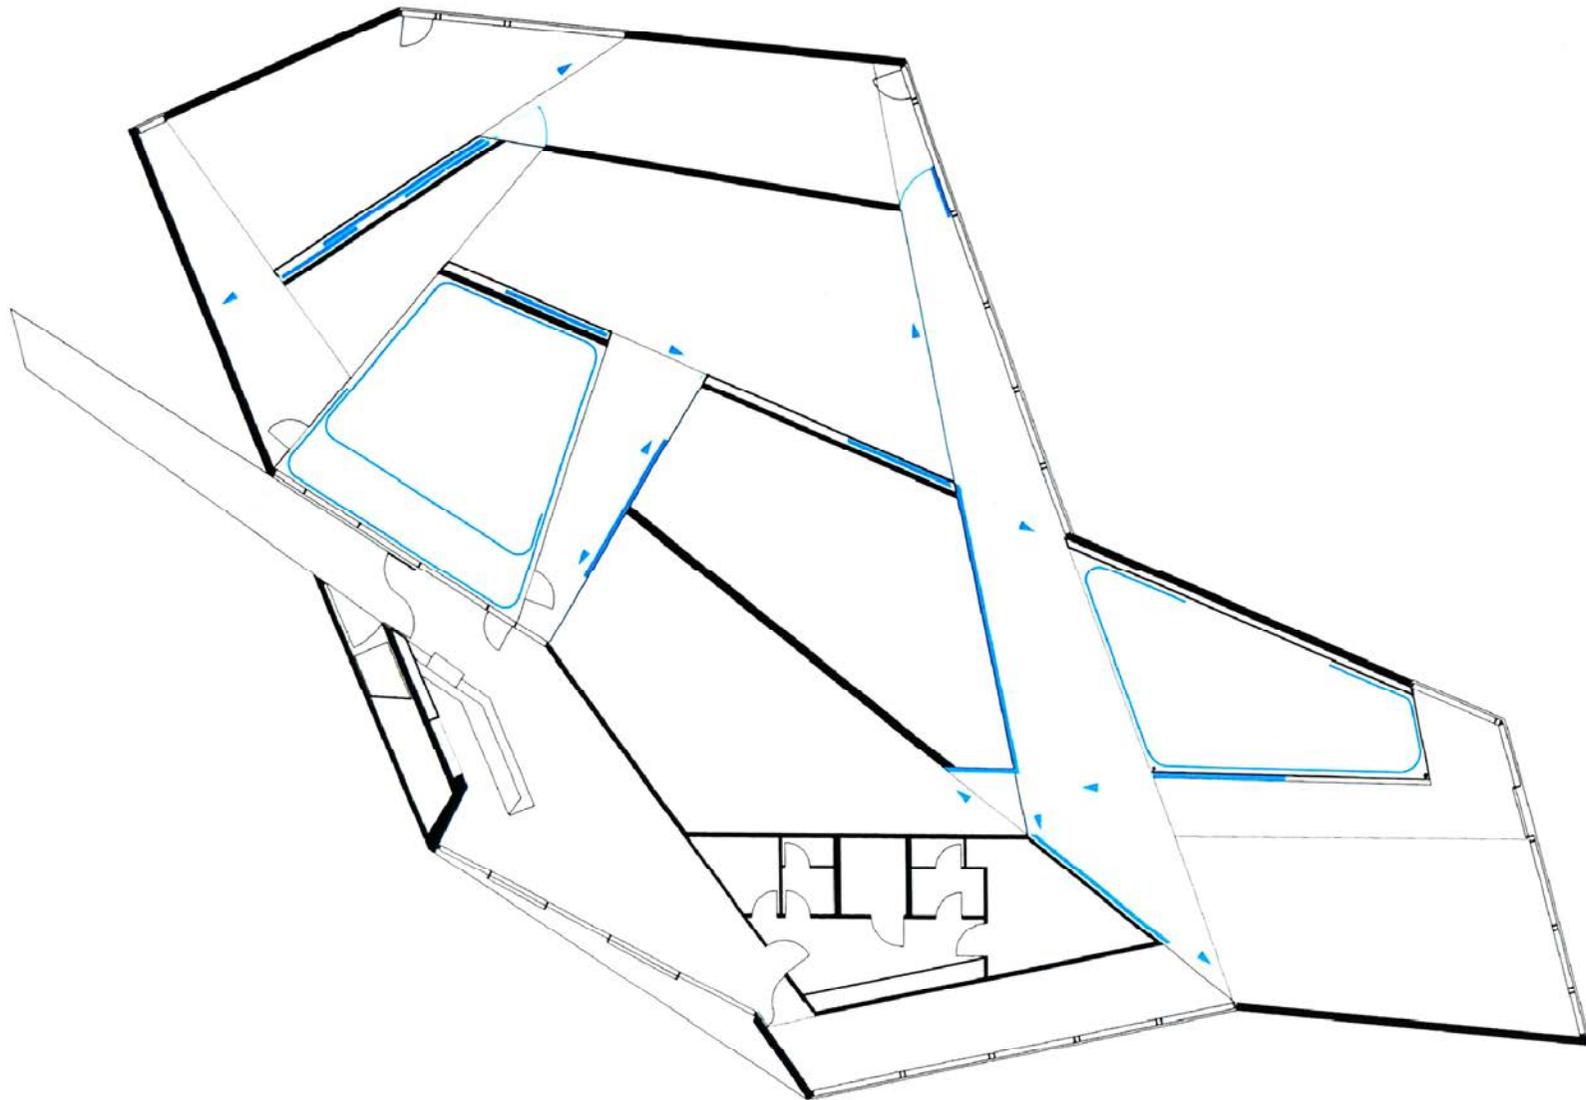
Grundriss Galerie der Zeitgenössischen Kunst, Grundeis, Kaindl, Teckert, & Steiner (2010) *Negotiating spaces : the new exhibition building of the Museum of Contemporary Art in Leipzig* by as-if berlinwien, S. 17
